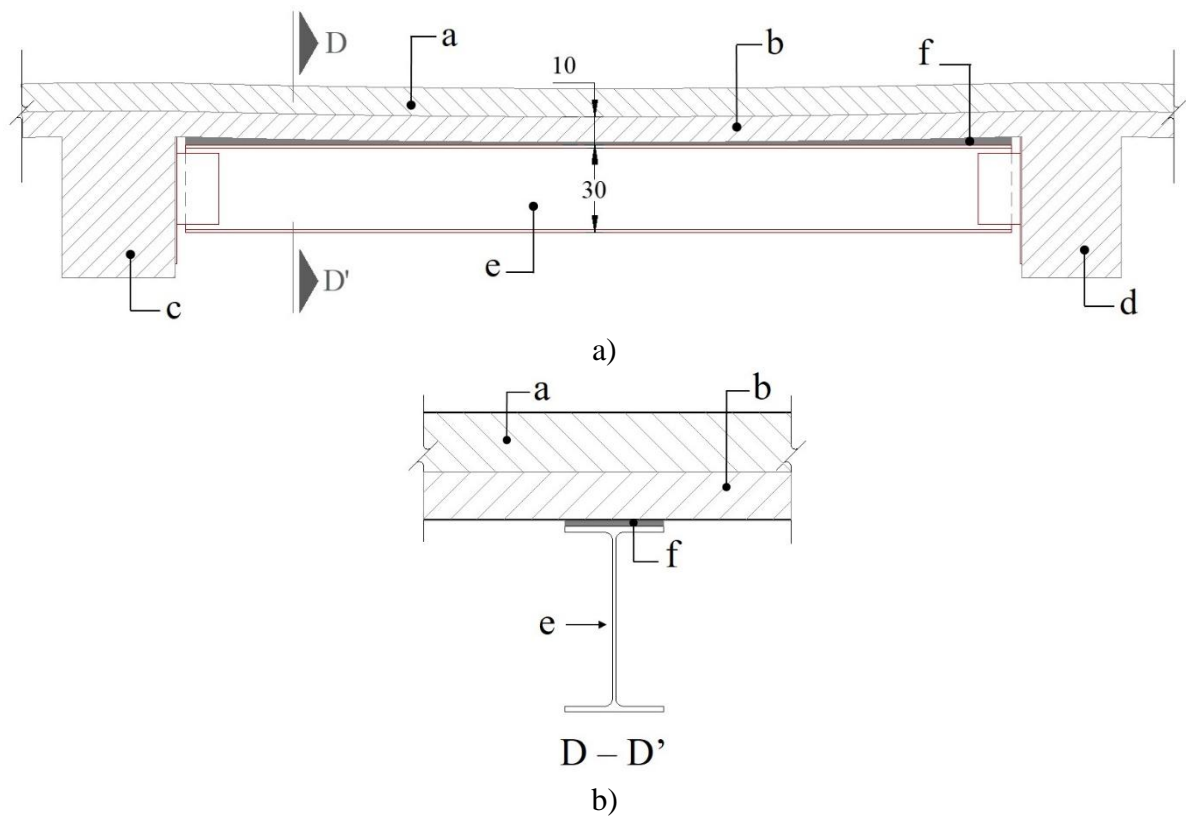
Viga terciária para dar suporte à laje maciça de concreto armado; a) vista longitudinal; b) vista transversal; onde: a = preenchimento de concreto simples, b = laje de concreto armado, c = viga principal de concreto armado, d = viga secundária de concreto armado, e = perfil de aço A-50 (IR 305 mm x 38.70 kg/m), f = preenchimento de microconcreto não metálico.
